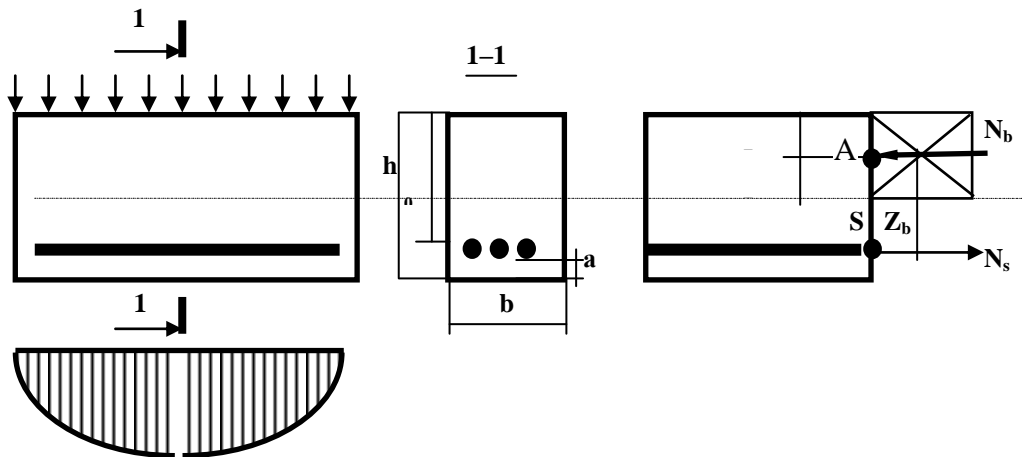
Схеми навантажень залізобетонного згинального елемента з одинарною арматурою
